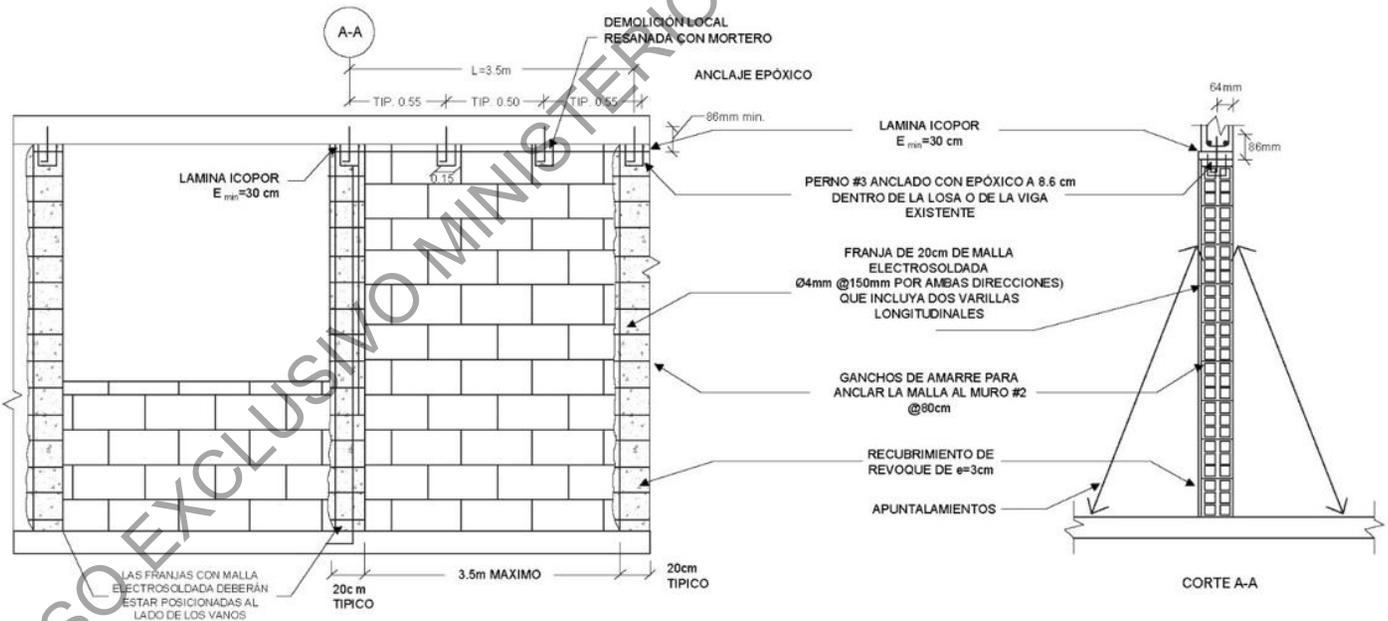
Refuerzo de muro existente con de revoque con malla.
